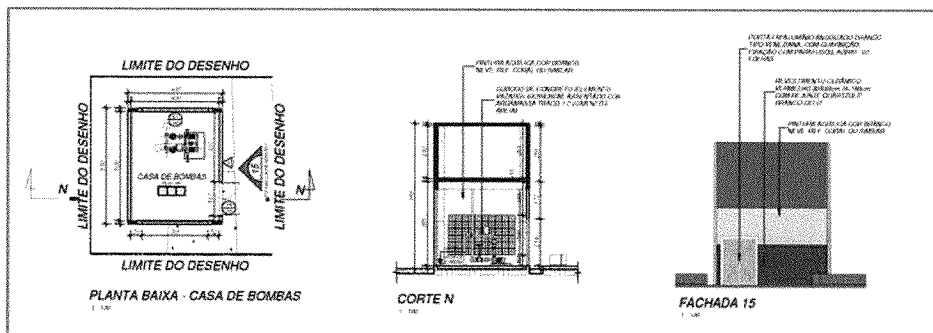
Casa de Bombas - Planta Baixa, Corte e Fachada
